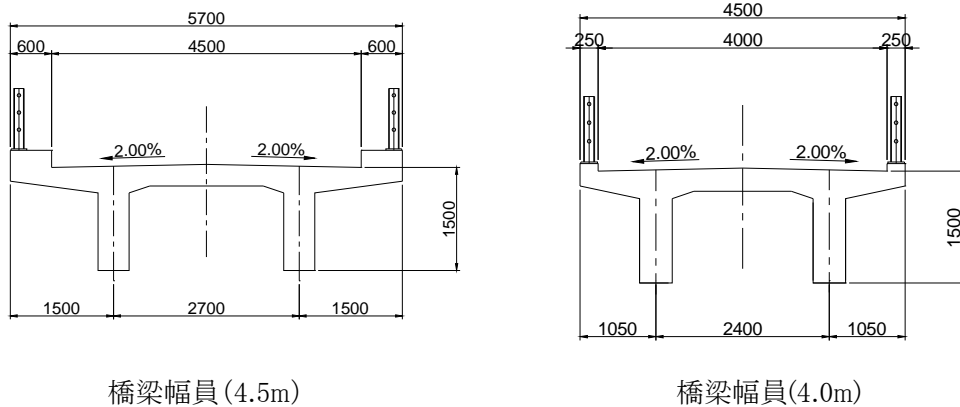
鉄筋コンクリート橋標準断面 出典：調査団
